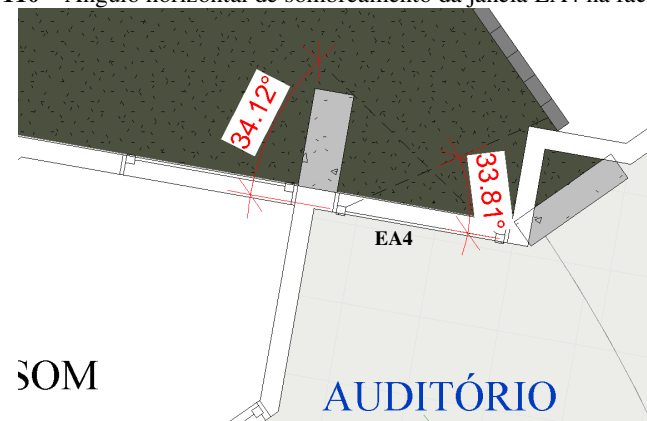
Ângulo horizontal de sombreamento da janela EA4-i na fachada norte
